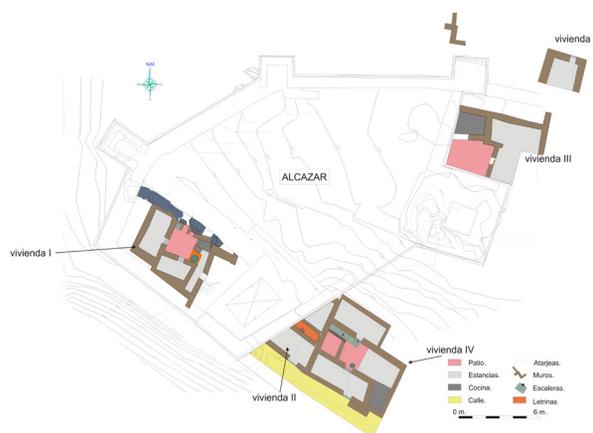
Planimetría de las viviendas andalusíes en el Castillo de Aracena (plano base Inmaculada Jiménez).
